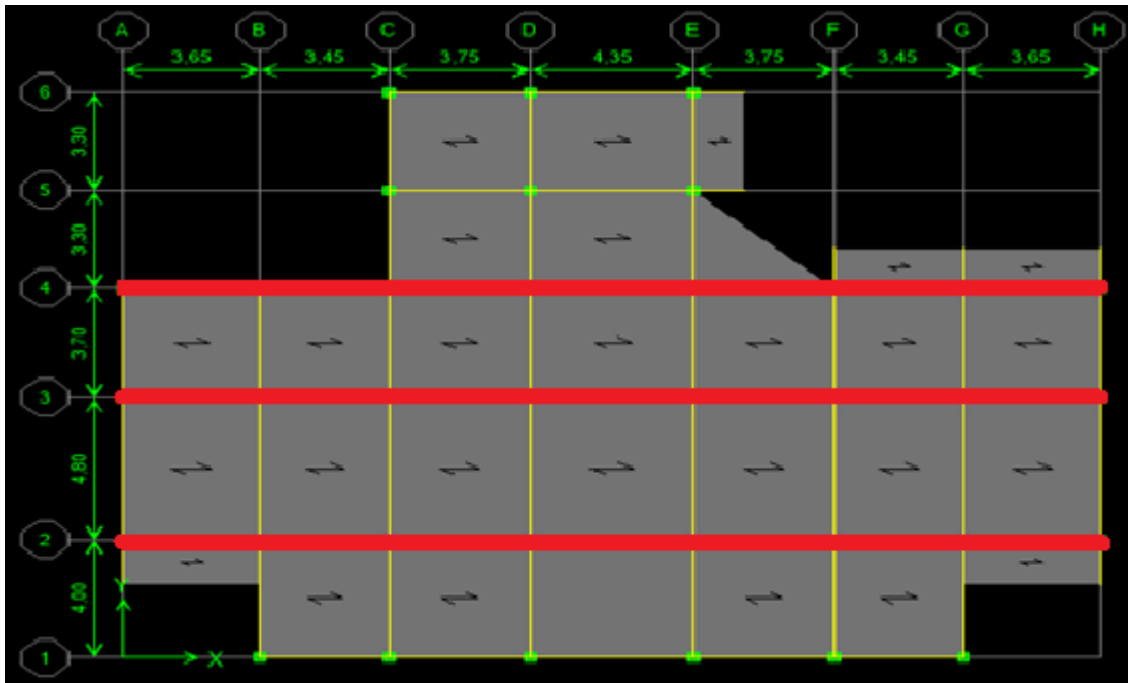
Poutres continues de la terrasse qui dépassant 25m
